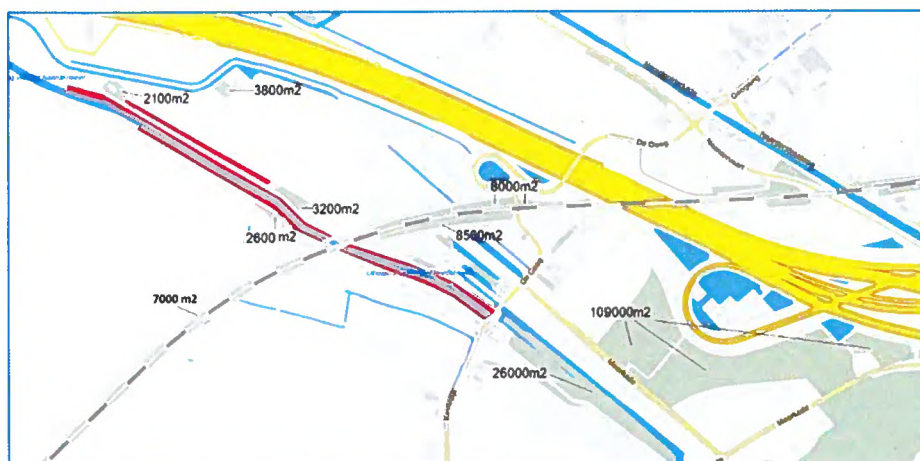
Ligging tijdelijke ontsluitingsweg vanaf parking Honswijk langs de A1.
